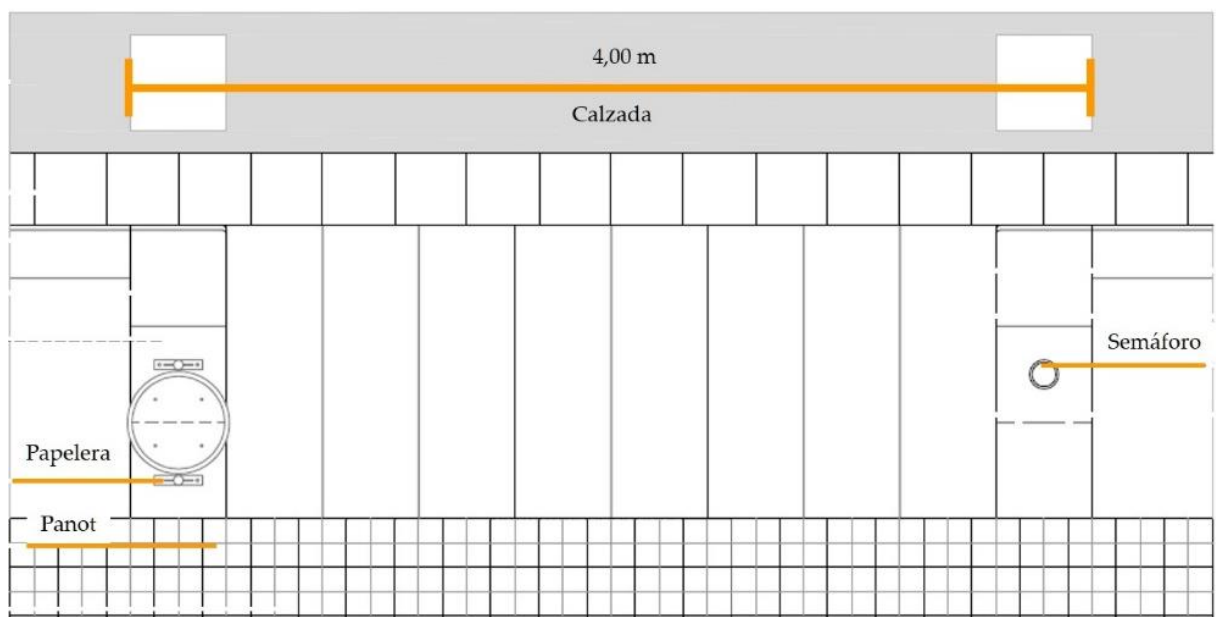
Planta vado tipo. FUENTE: Ayuntamiento de barcelona
